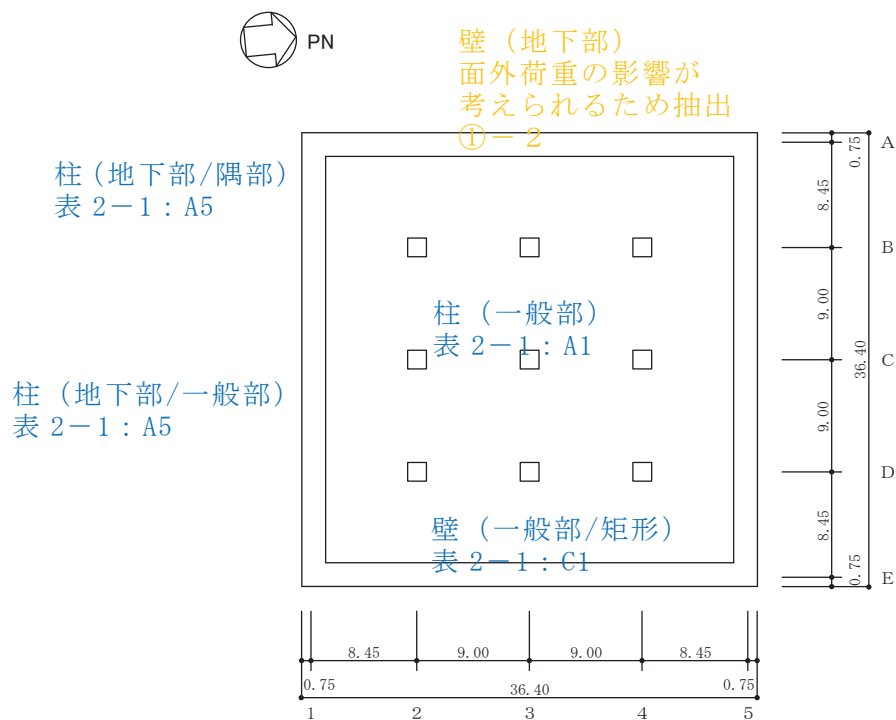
(2) 緊急時対策建屋の概略平面図 (0. P. 57. 3m) (単位 : m)
